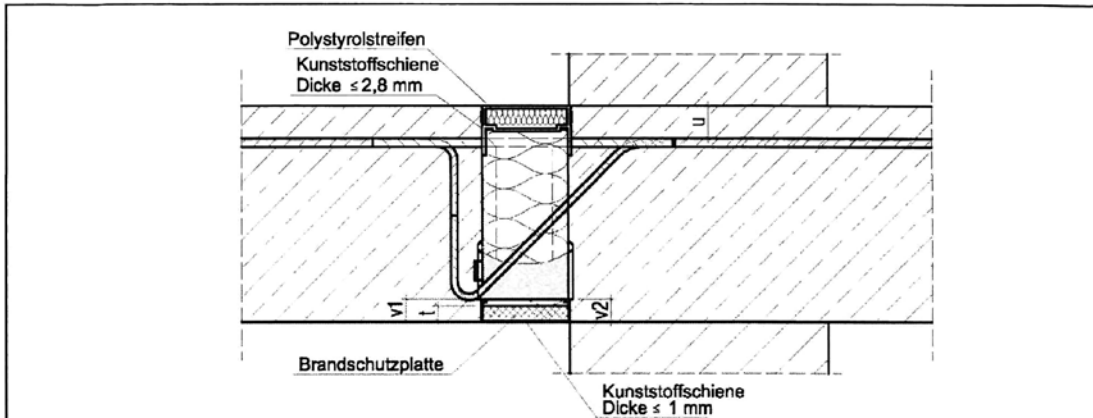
Schöck Isokorb Typ K und Typ KF (Ausführungsvariante B) gem. Abschnitt 2.1.3
